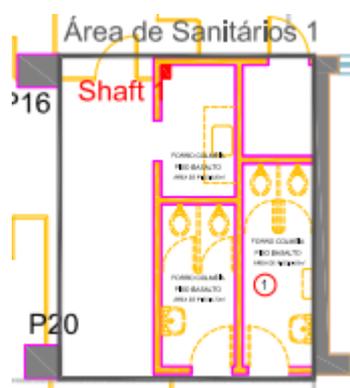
Planta de demolição –sanitário existente (3ºpavimento)
